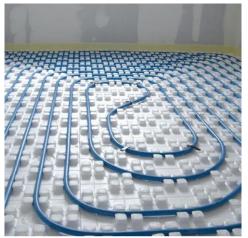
Plancher rafraichissant ou chauffant, principe général.
